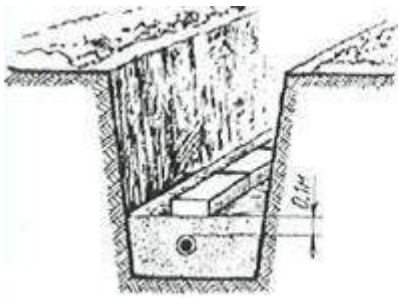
Дополнительная защита кабеля от возможных механических повреждений
